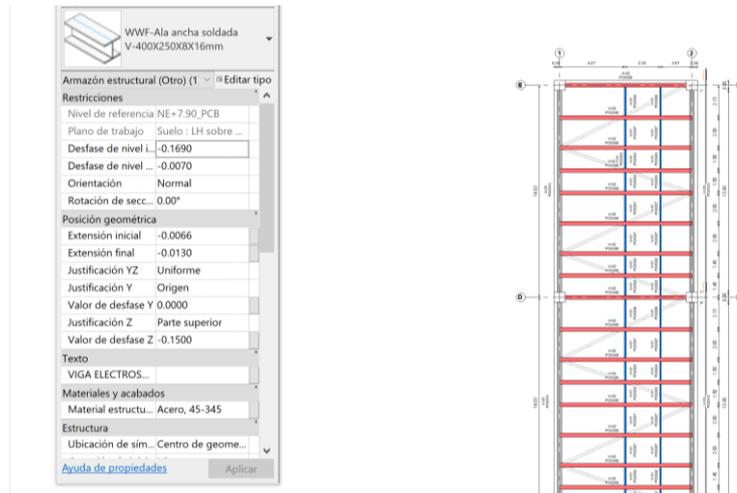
vigas estructurales losa ejes 1-2, fuente Modelo estructural propia
